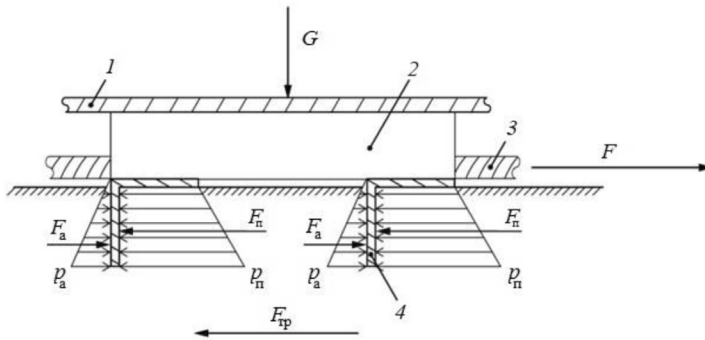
Фрагмент нижней части наполняемой мобильной гравитационно-анкерной опоры: 1 – дно наполняемой емкости; 2 – соединительный продольный элемент секции грунтозацепов; 3 – продольная гибкая связь основания опоры; 4 – грунтозацеп [6]
